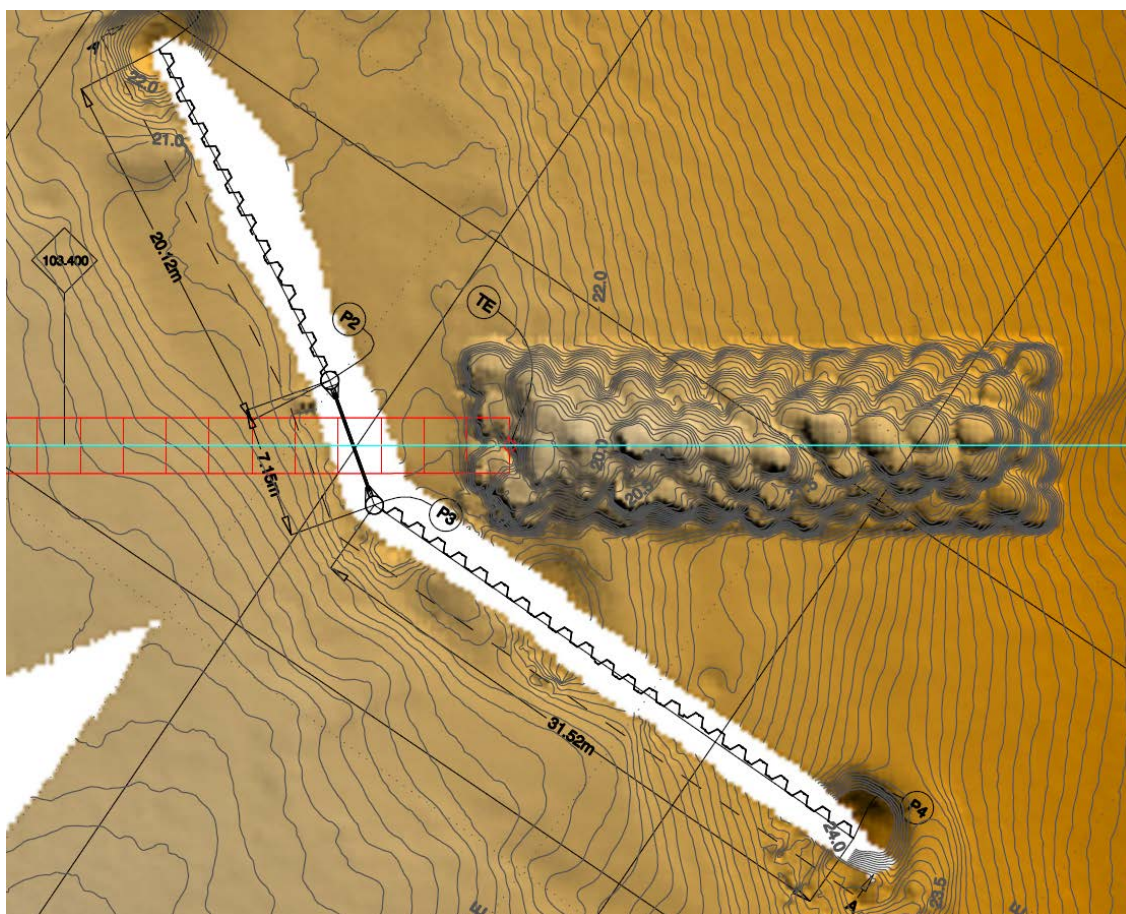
Configurazione "as built" delle opere temporanee all'exit point rilevata con Muti Beam
